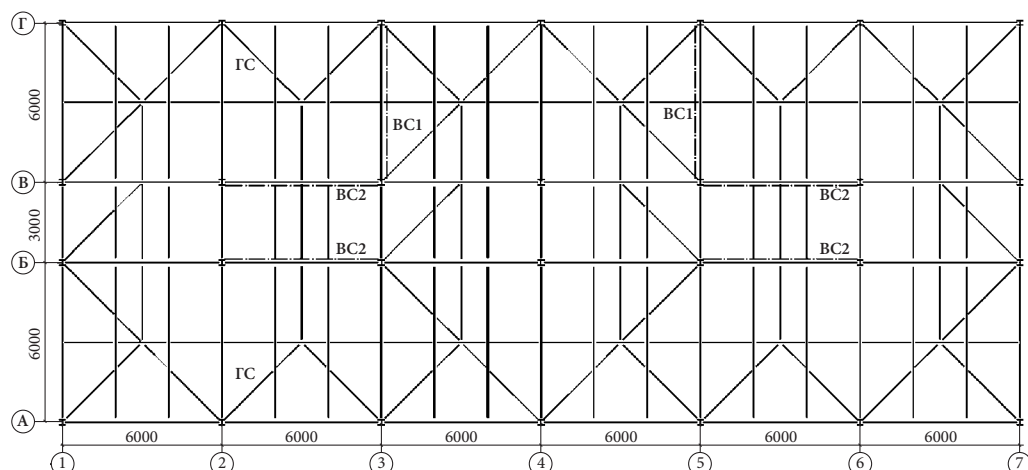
Пример расположения связей между балками при перекрытиях из профилированного настила
